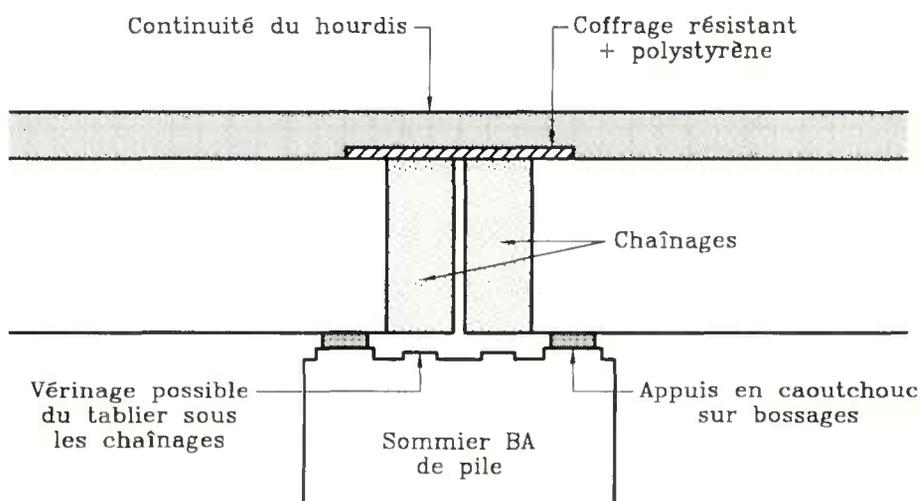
Principe de la continuité apparente par dalle en béton armé.
